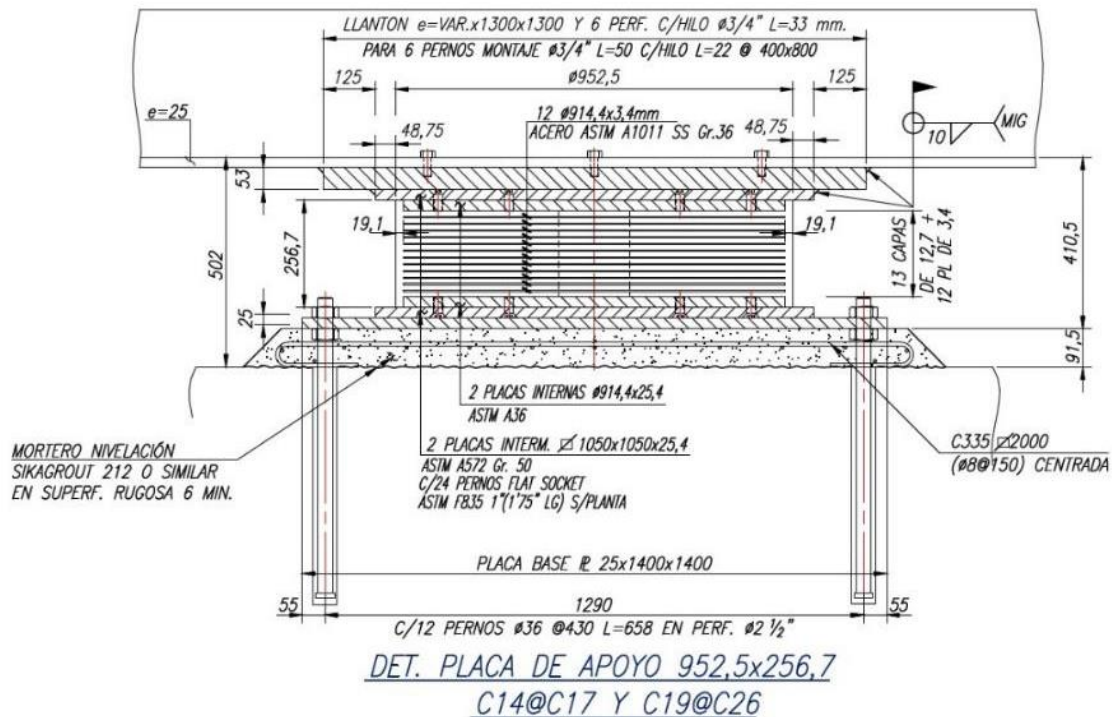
1 Elevación Frontal Placa de Apoyo (Astaburuaga, 2020).
